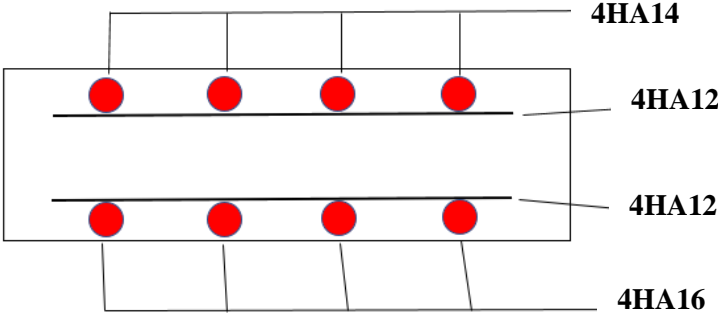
Ferrailage de la dalle dans le sens transversal
